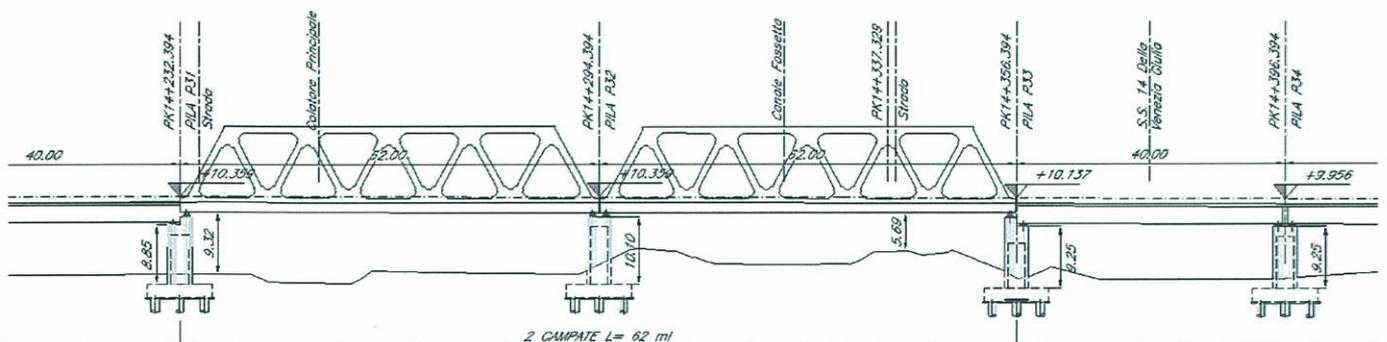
Prospetto dell’attraversamento del Canale Fossetta e della S.S. 14 della Venezia Giulia.
